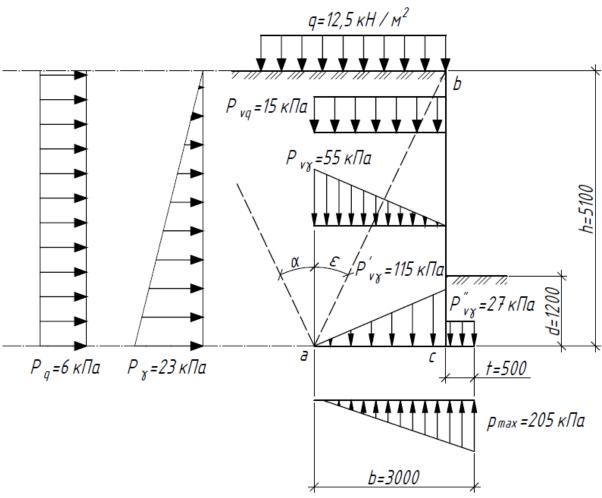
Схема воздействия нагрузок на тонкостенную подпорную стену при расчете ее на прочность.
